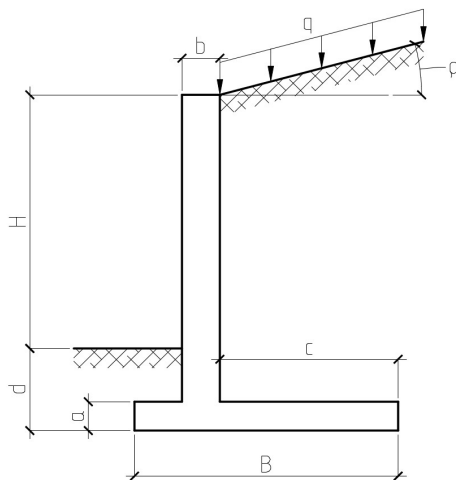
Схема тонкостенной угловой подпорной стены
